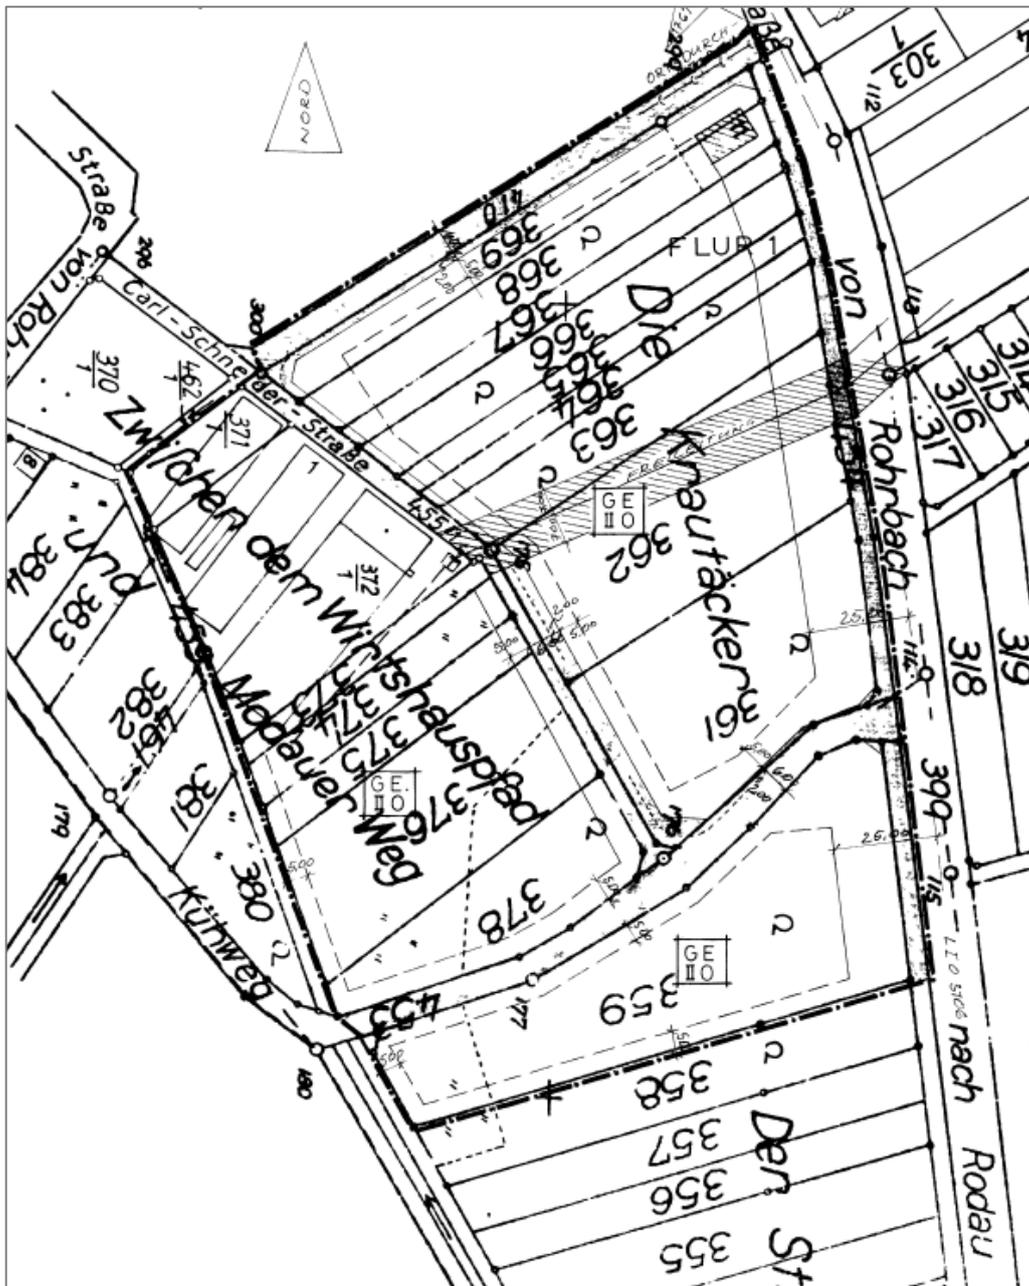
Bebauungsplan „Am Südlichen Ortsausgang“
